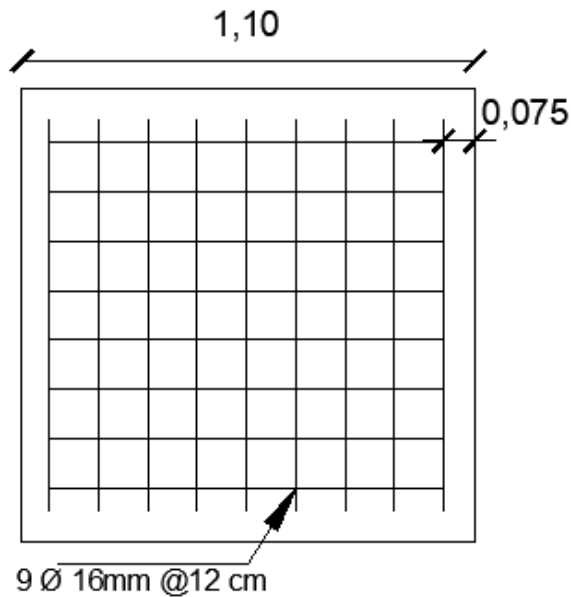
Detalle de varillado en zapata - Vista en Planta
